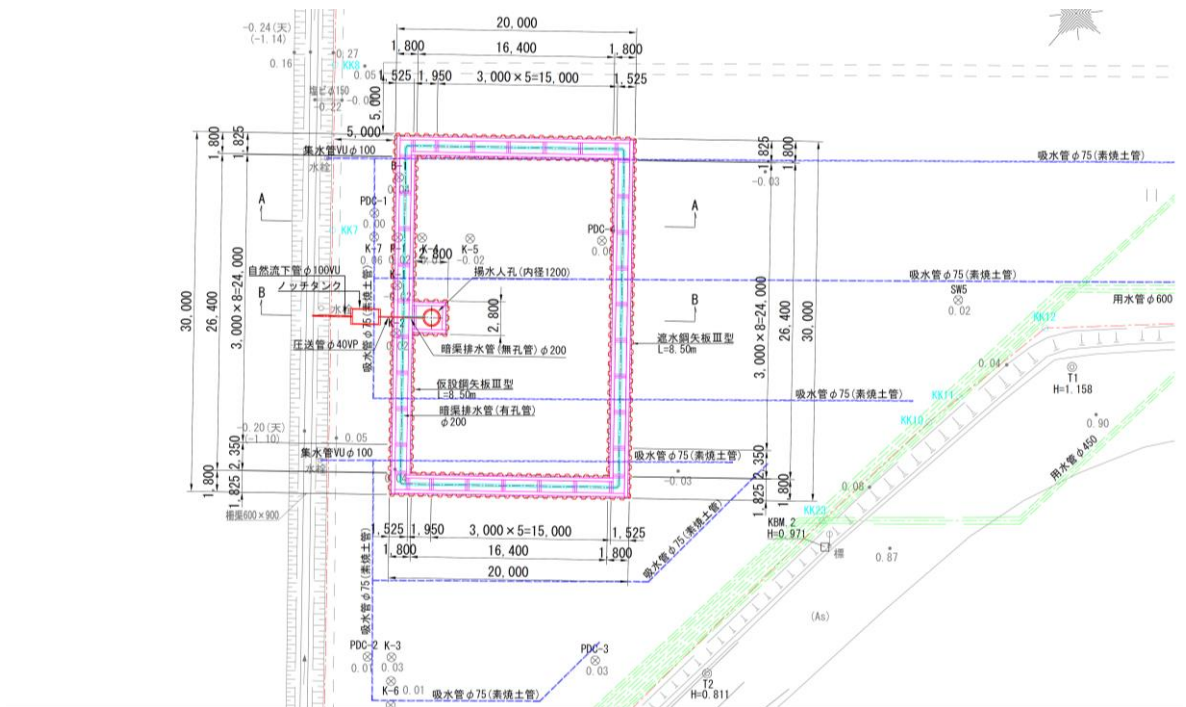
試験施工エリアの詳細平面図（六角地区）
